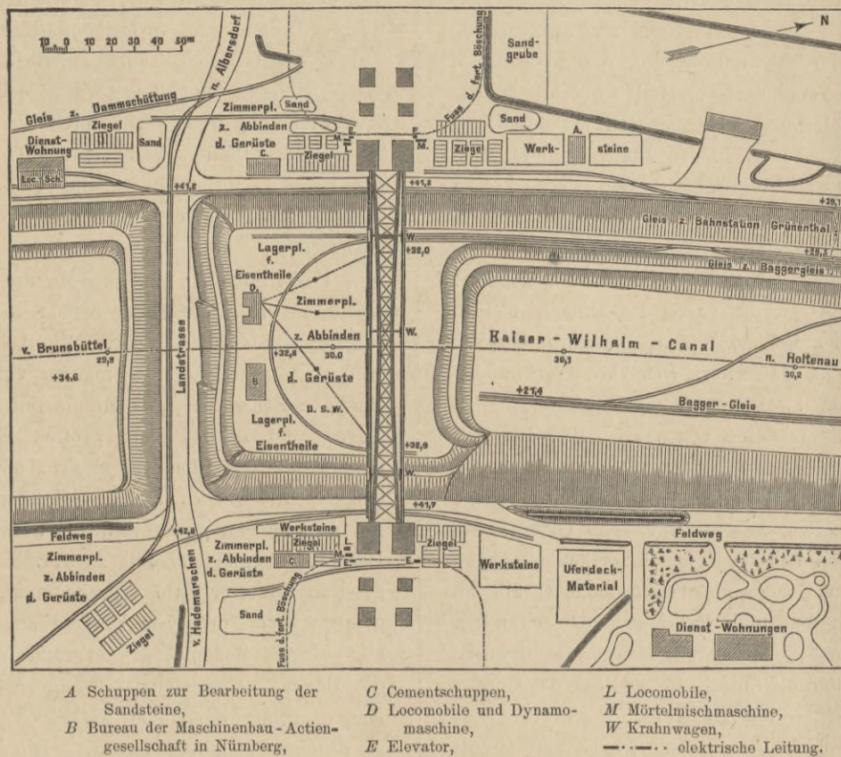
Lageplan der Brückenbaustelle bei Grünenthal.
